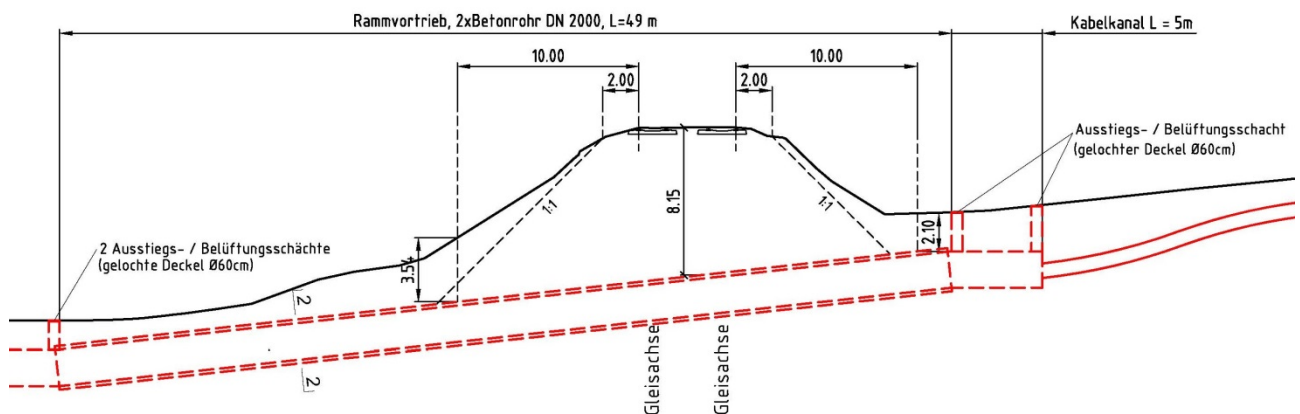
Längsschnitt Unterpressung SBB. Ausschnitt aus Plan EEL-10112.
